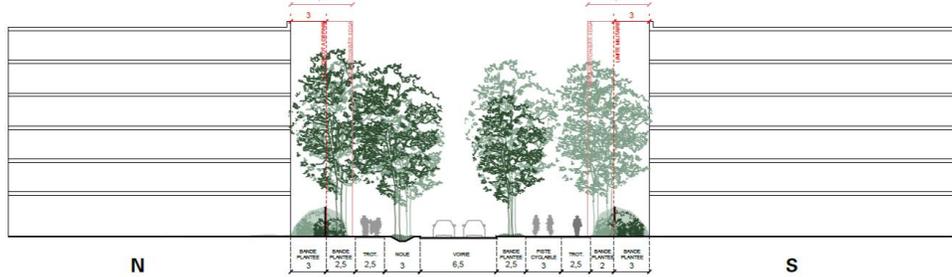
COUPES TRANSVERSALES DE LA ZONE DU PLAN
